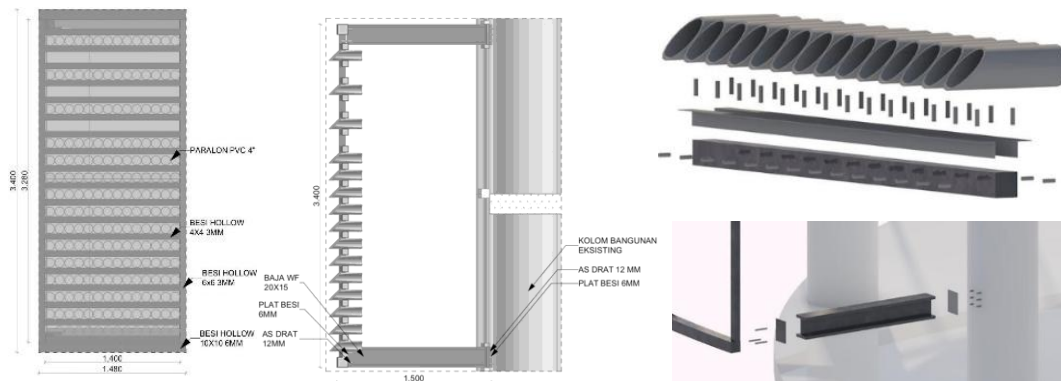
Gambar Denah & Tampak Bangunan Eksisting dan Rancangan *Light Diffuser
